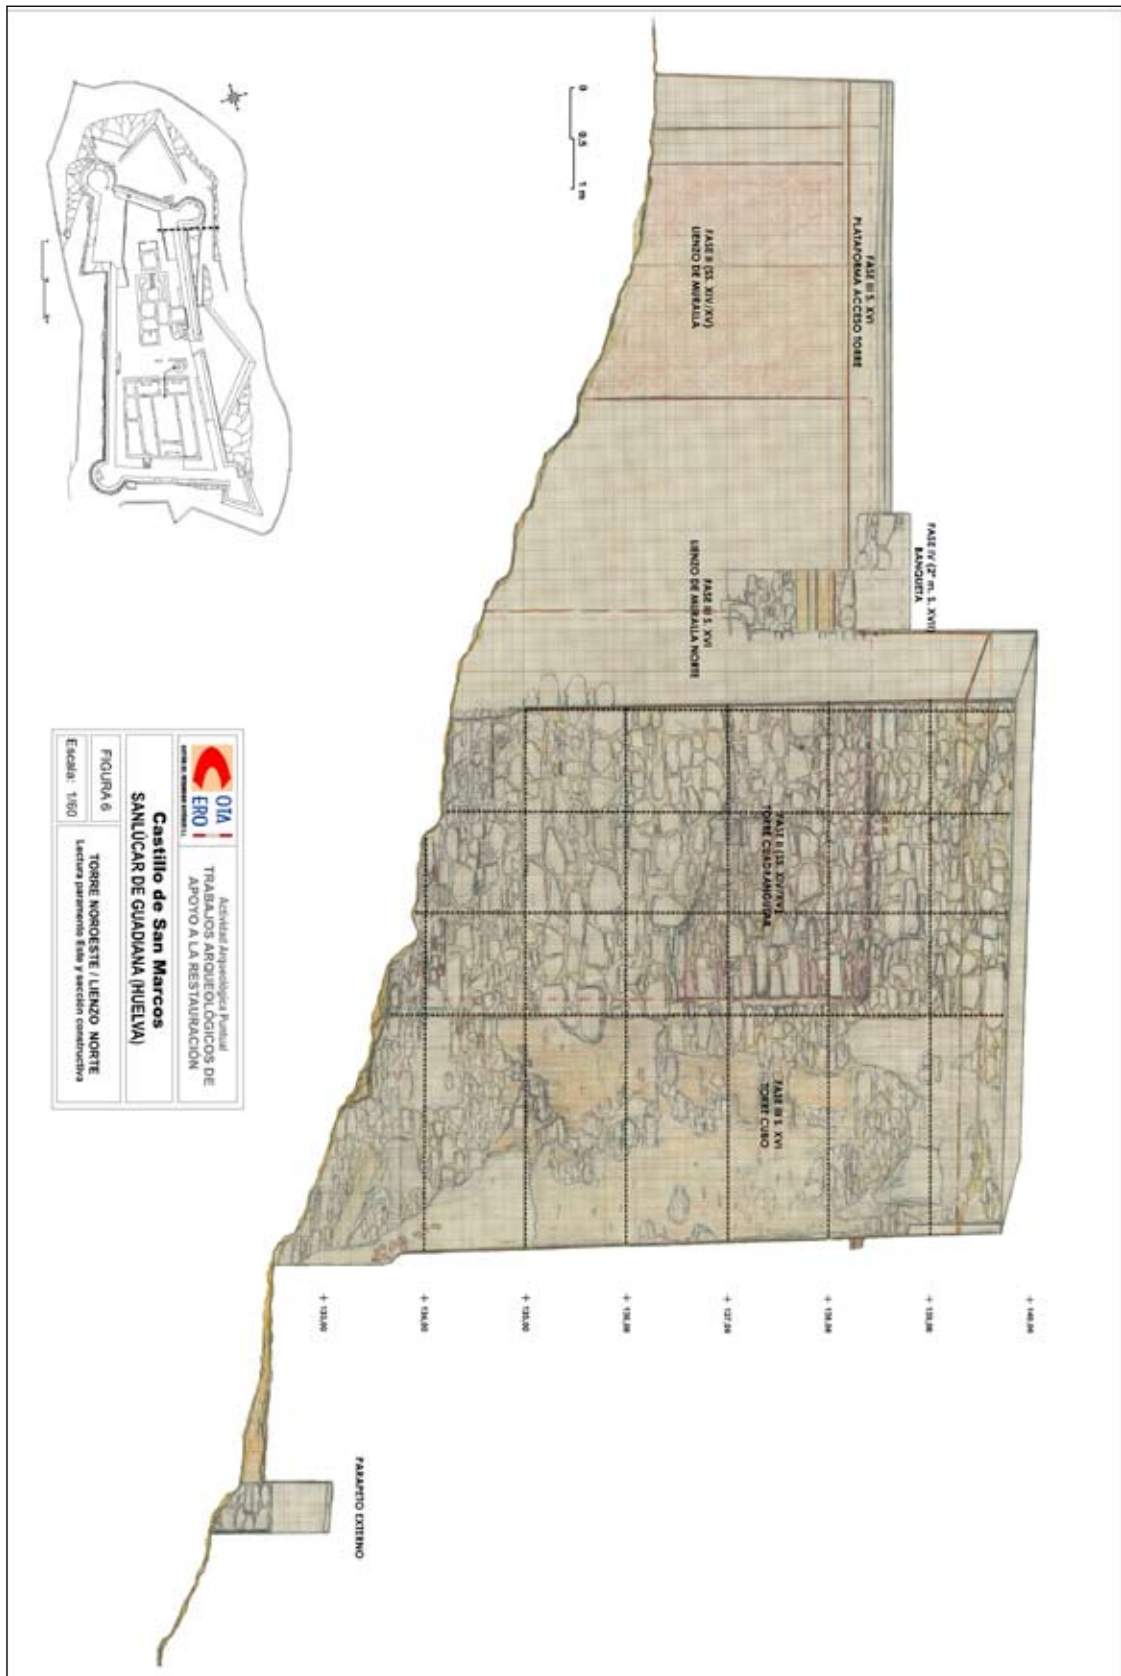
Torre Noroeste: área 1 de análisis paramental. Sección constructiva.
